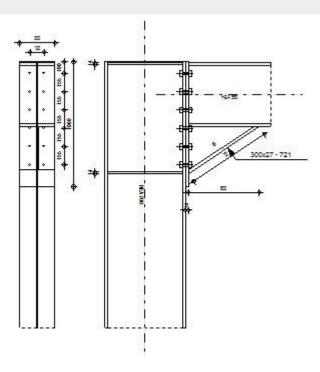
Vérification de l'assemblage poteau-poutre
